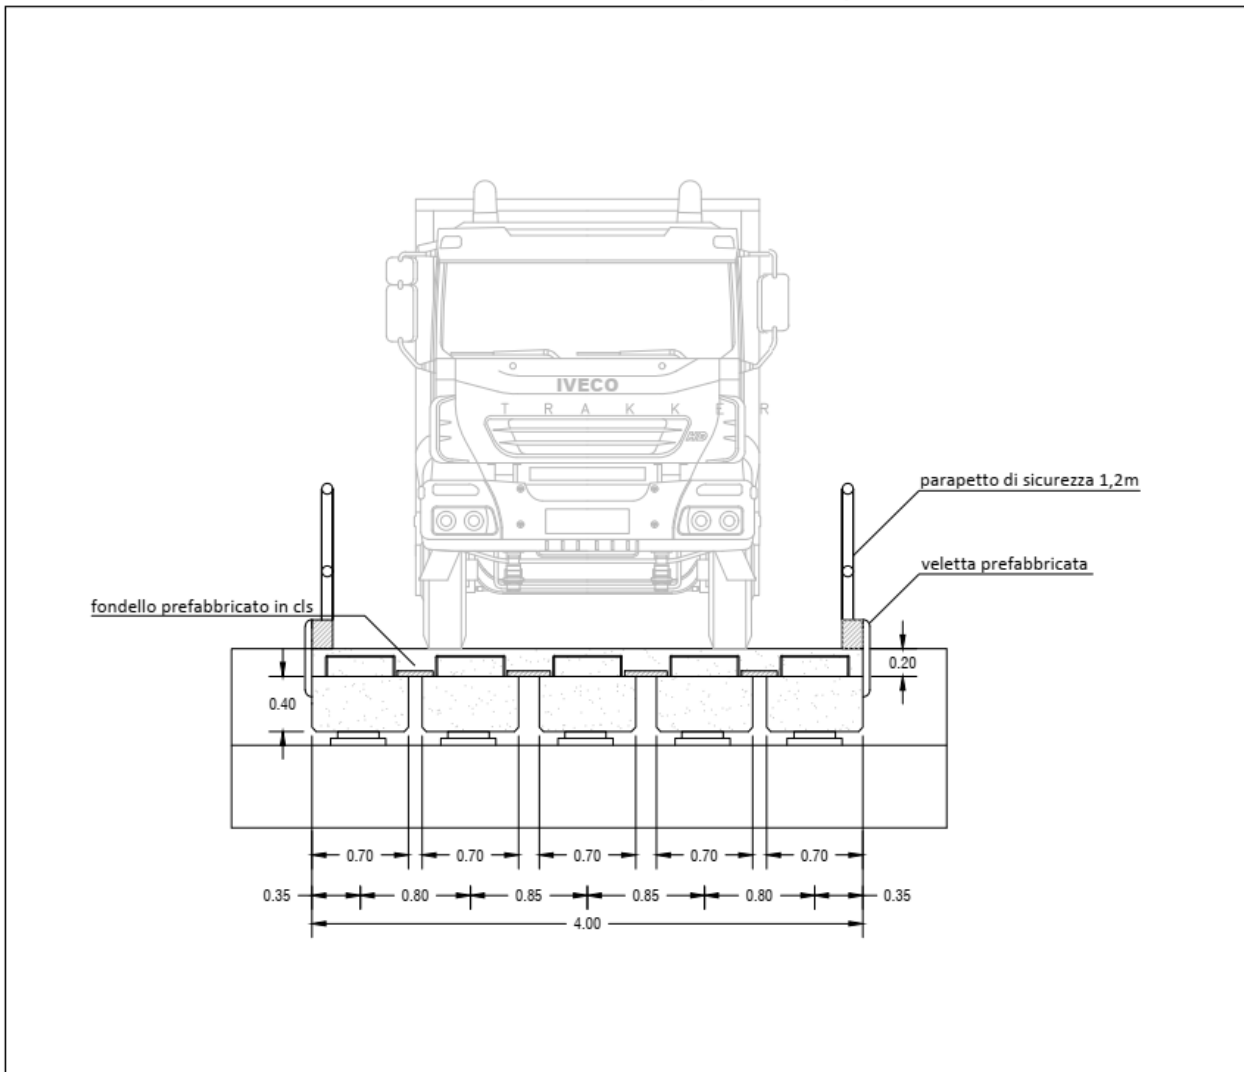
Dettaglio strutturale – sezione impalcato + soletta
